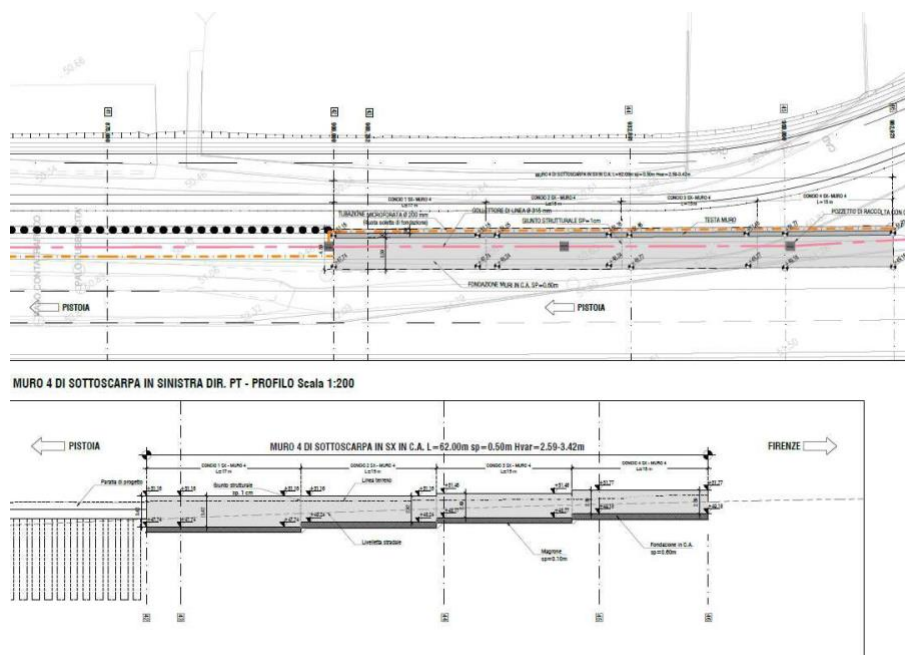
Stralcio planimetrico e prospetto muri di sottoscarpa 4 asse Sx in direzione Firenze
